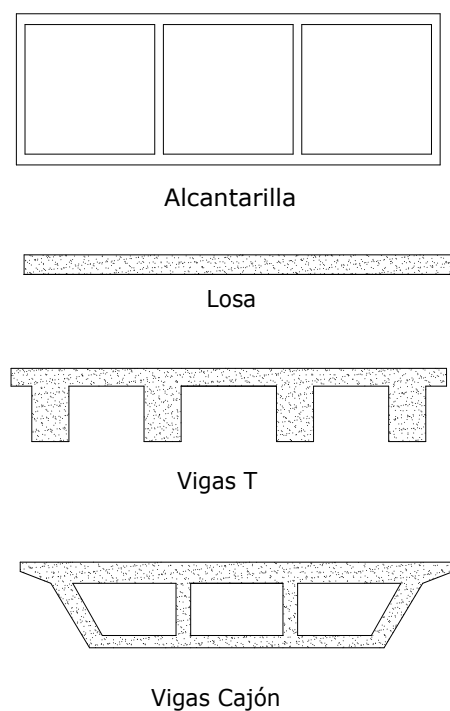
Secciones típicas de hormigón armado en superestructuras de puentes
